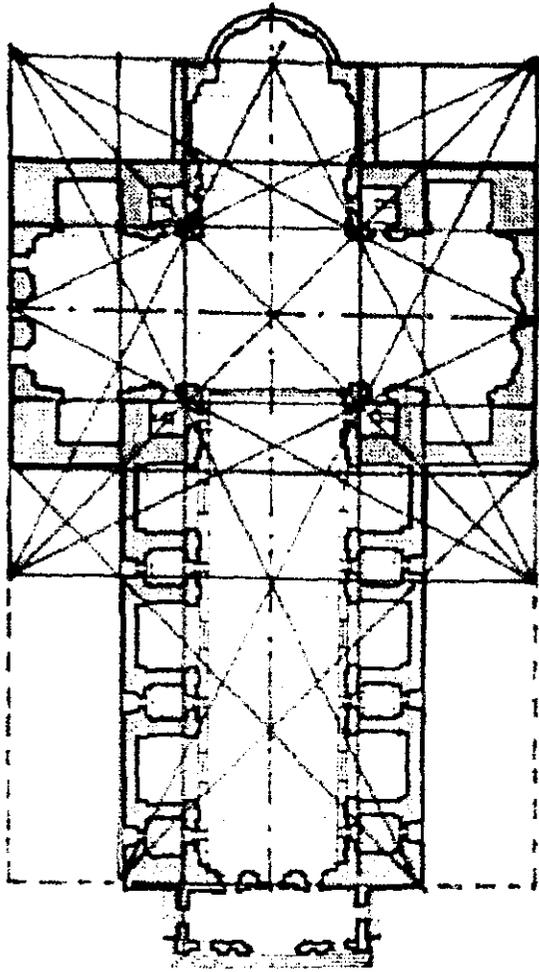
Trazo de la planta de Sant'Andrea (Mantua)
